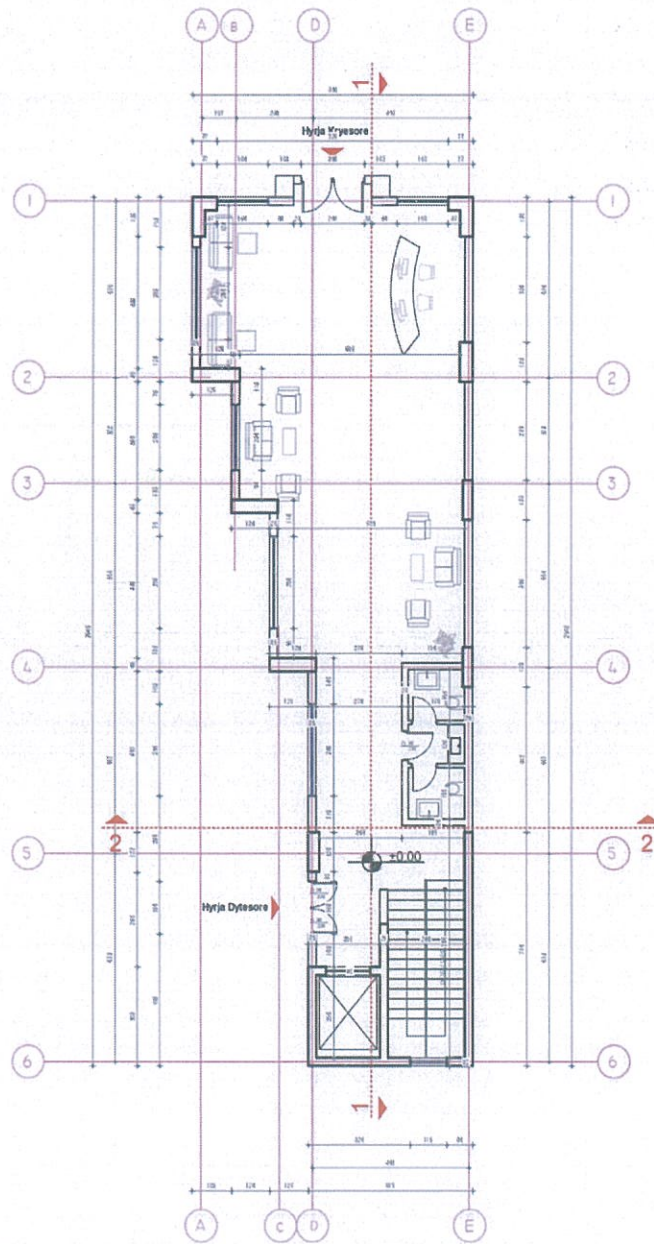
Planimetri e katit përdhe (kuota 0.00)
